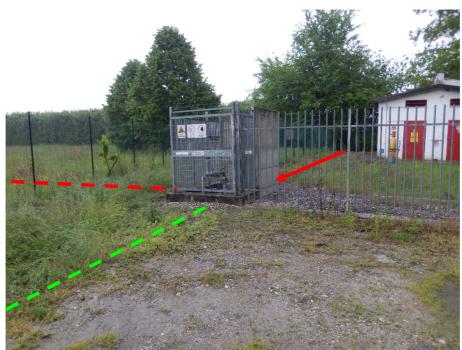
ALLACCIAMENTO IMPIANTO PIDA
